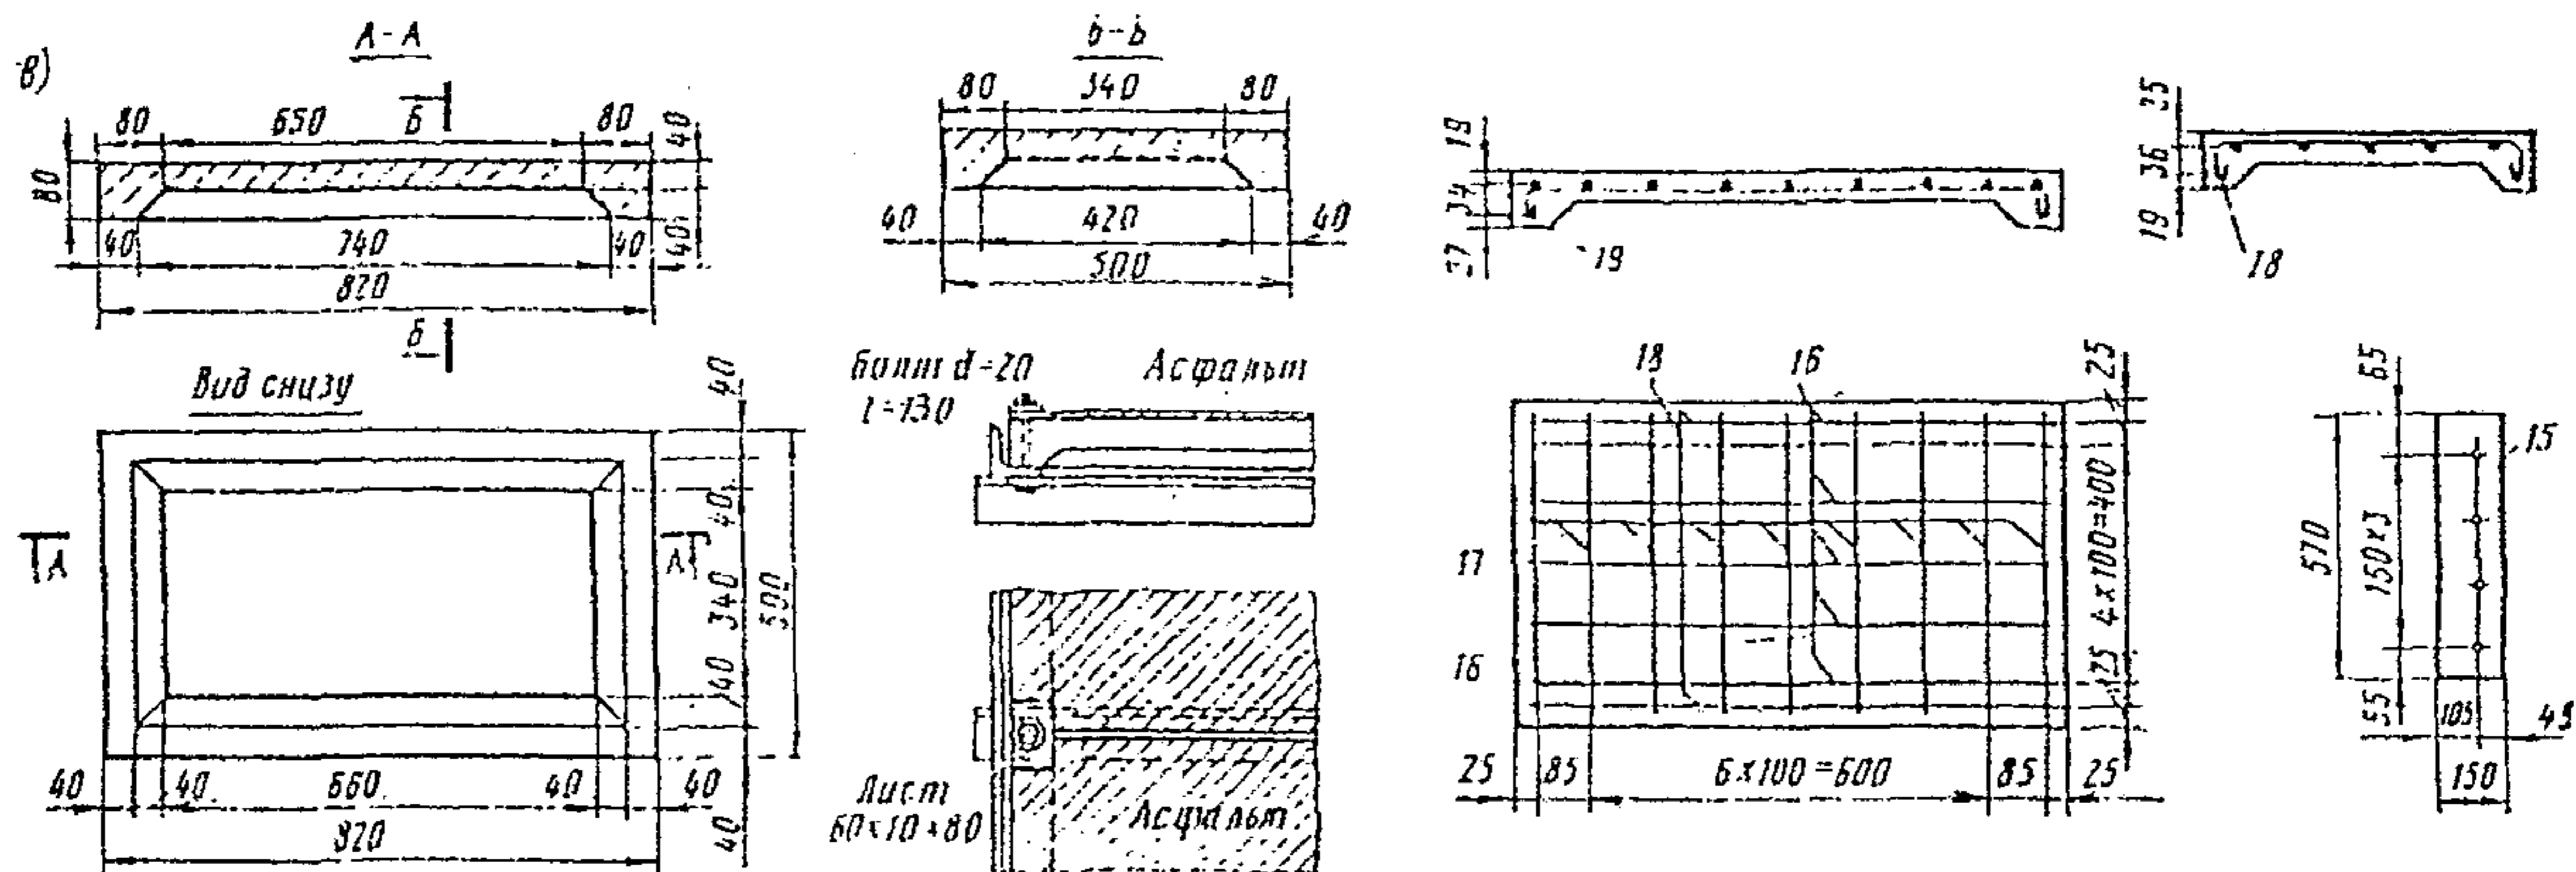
Плита тротуара (фасад, разрезы А-А, Б-Б, схема армирования, схема установки)
